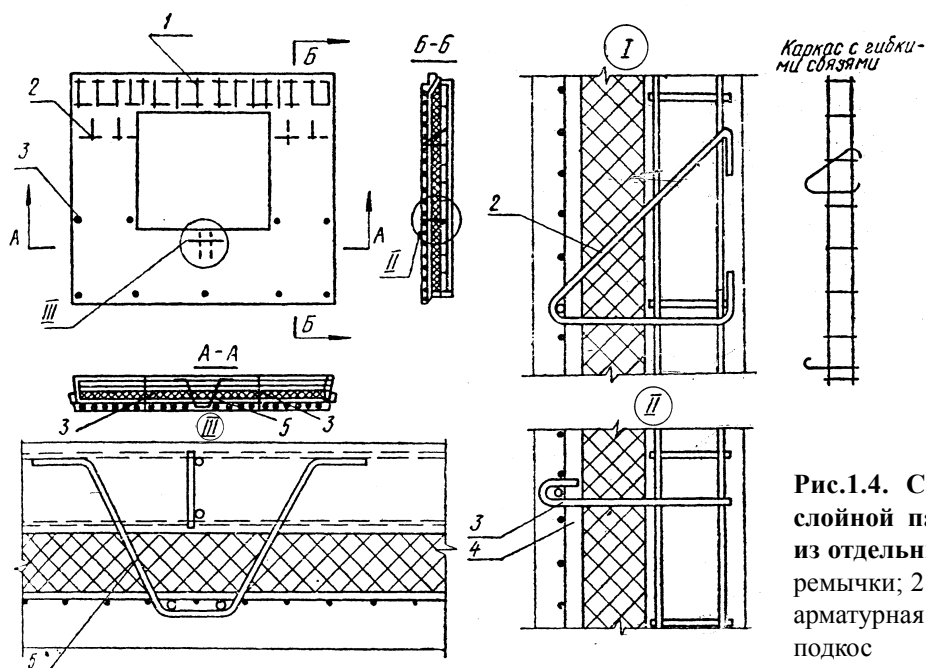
Схема армирования трехслойной панели с гибкими связями из отдельных стержней: 1 - каркас перемычки; 2 - подвеска; 3 - распорка; 4 - арматурная сетка наружного слоя; 5 - подкос
